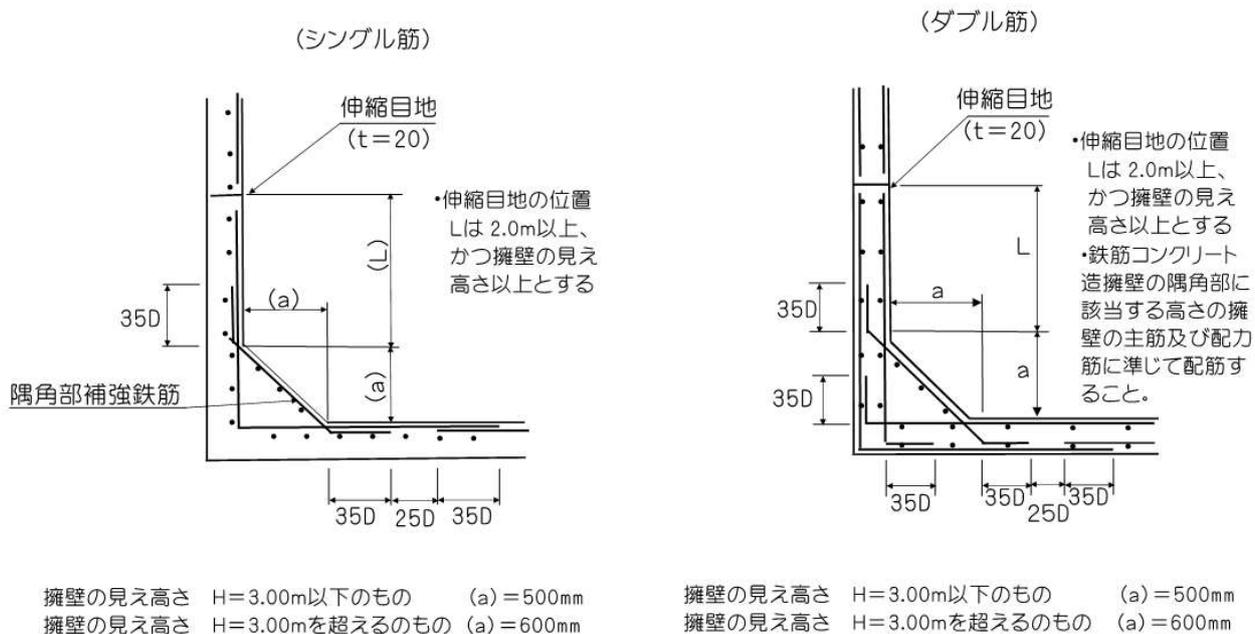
L型鉄筋コンクリート擁壁の配筋要領
